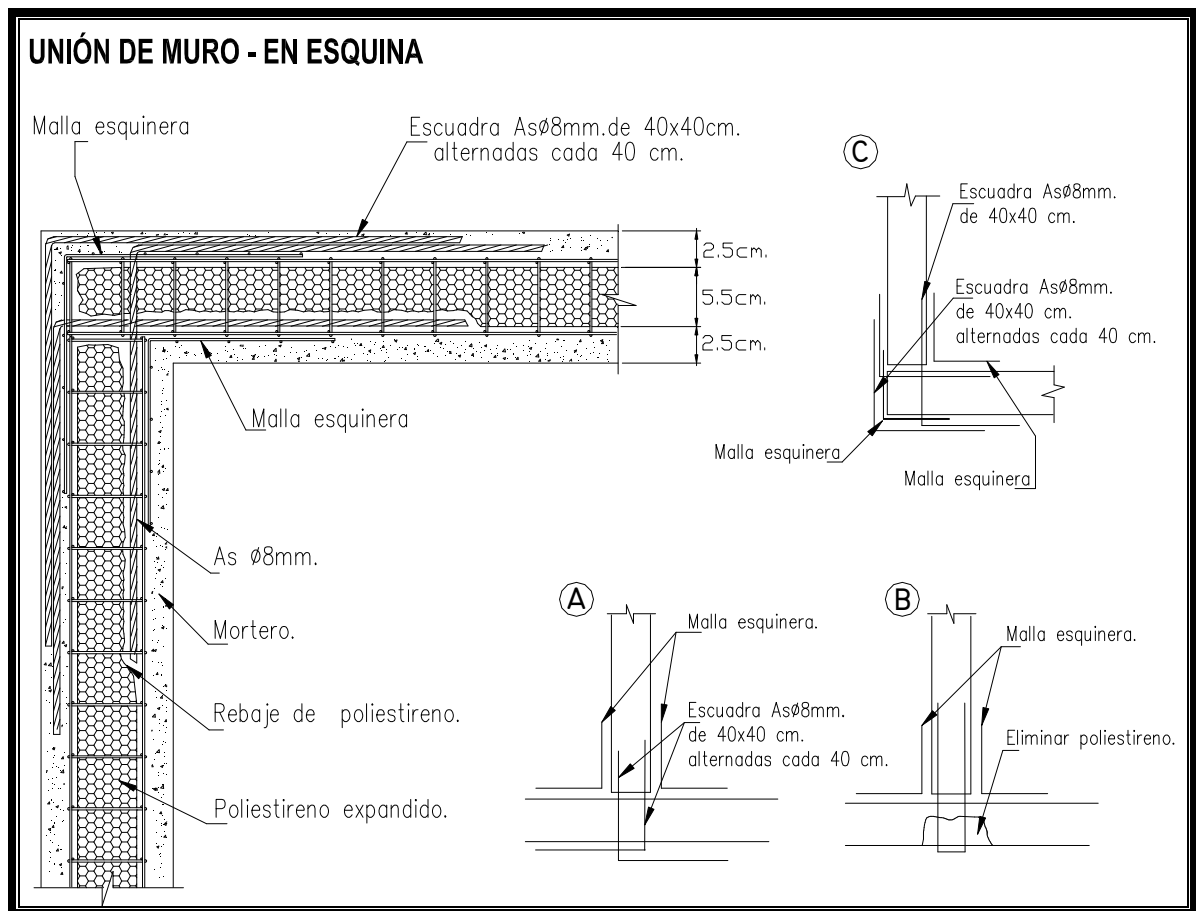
Detalle de colocación de acero de refuerzo en la unión de muros en esquinas
